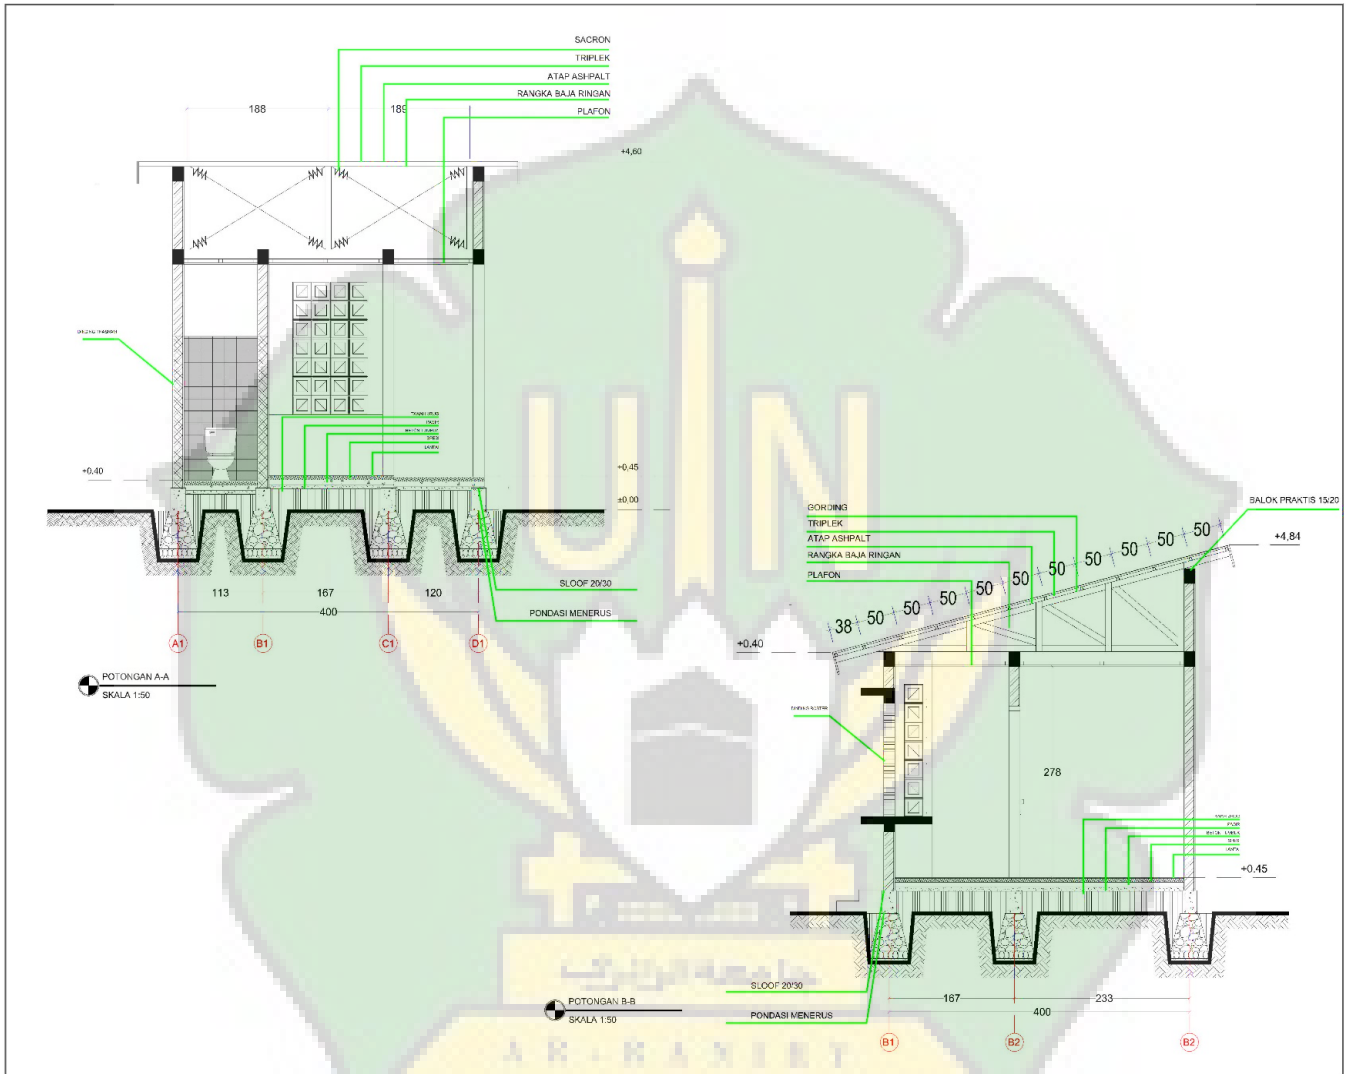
Potongan Mushalla (A-A dan B-B)
